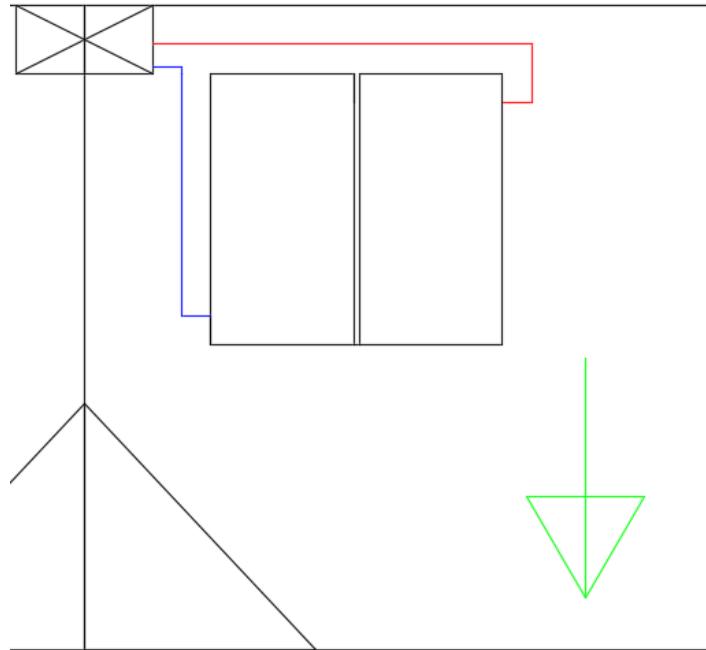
Layout del campo solar de captadores planos [AutoCAD]
